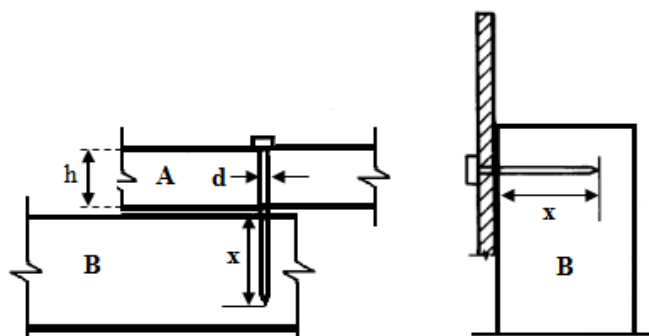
Fixação de peças de madeira e metálica utilizando pregos
